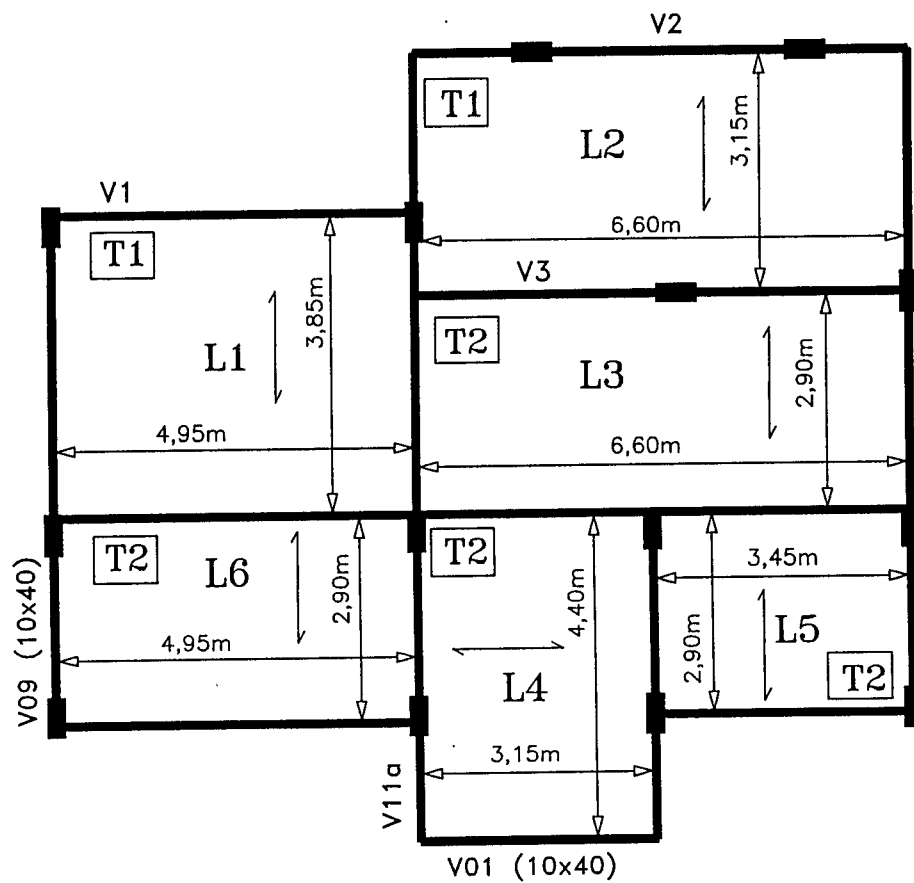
ESTRUTURA 1.1 - ESQUEMA - LAJE PRÉ-MOLDADA
